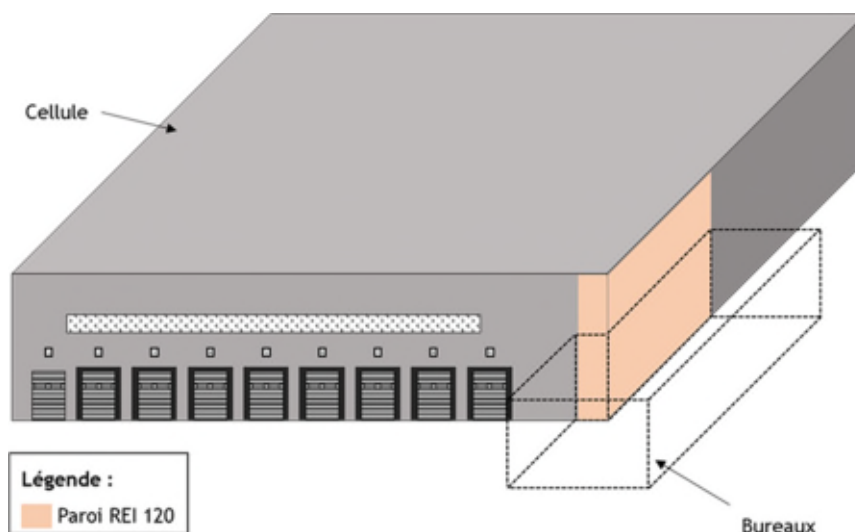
Plan des dispositions constructives des parois entre bureaux et cellules (Bureau n° 1)
